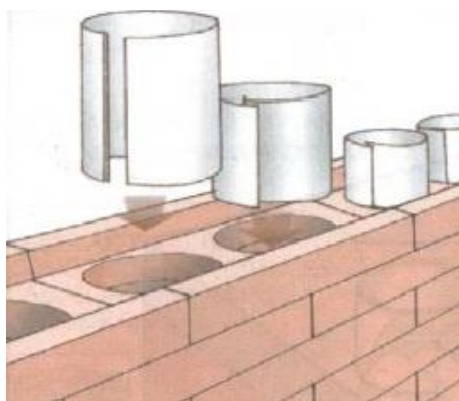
Detalhes da desobstrução dos furos com canos de PVC cortados para preenchimento das canaletas
